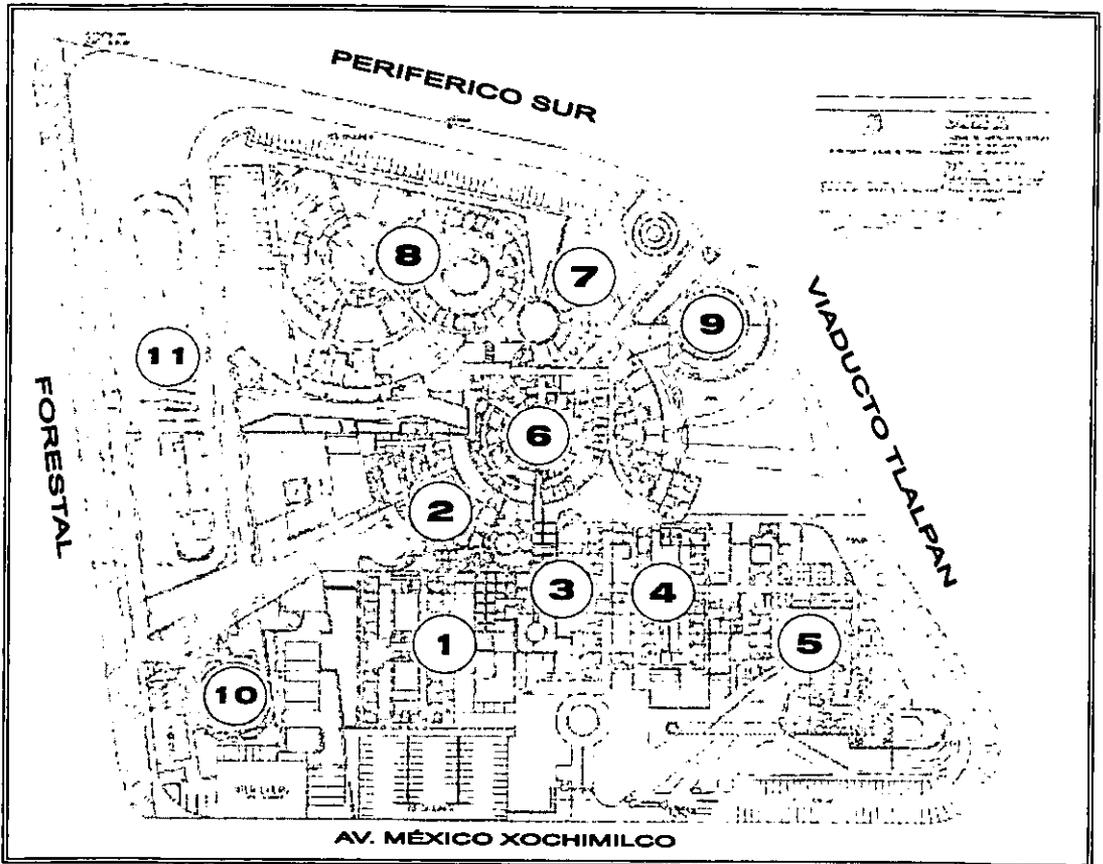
Plano estructural de la Planta Baja de conjunto del Centro Nacional de Rehabilitación.
